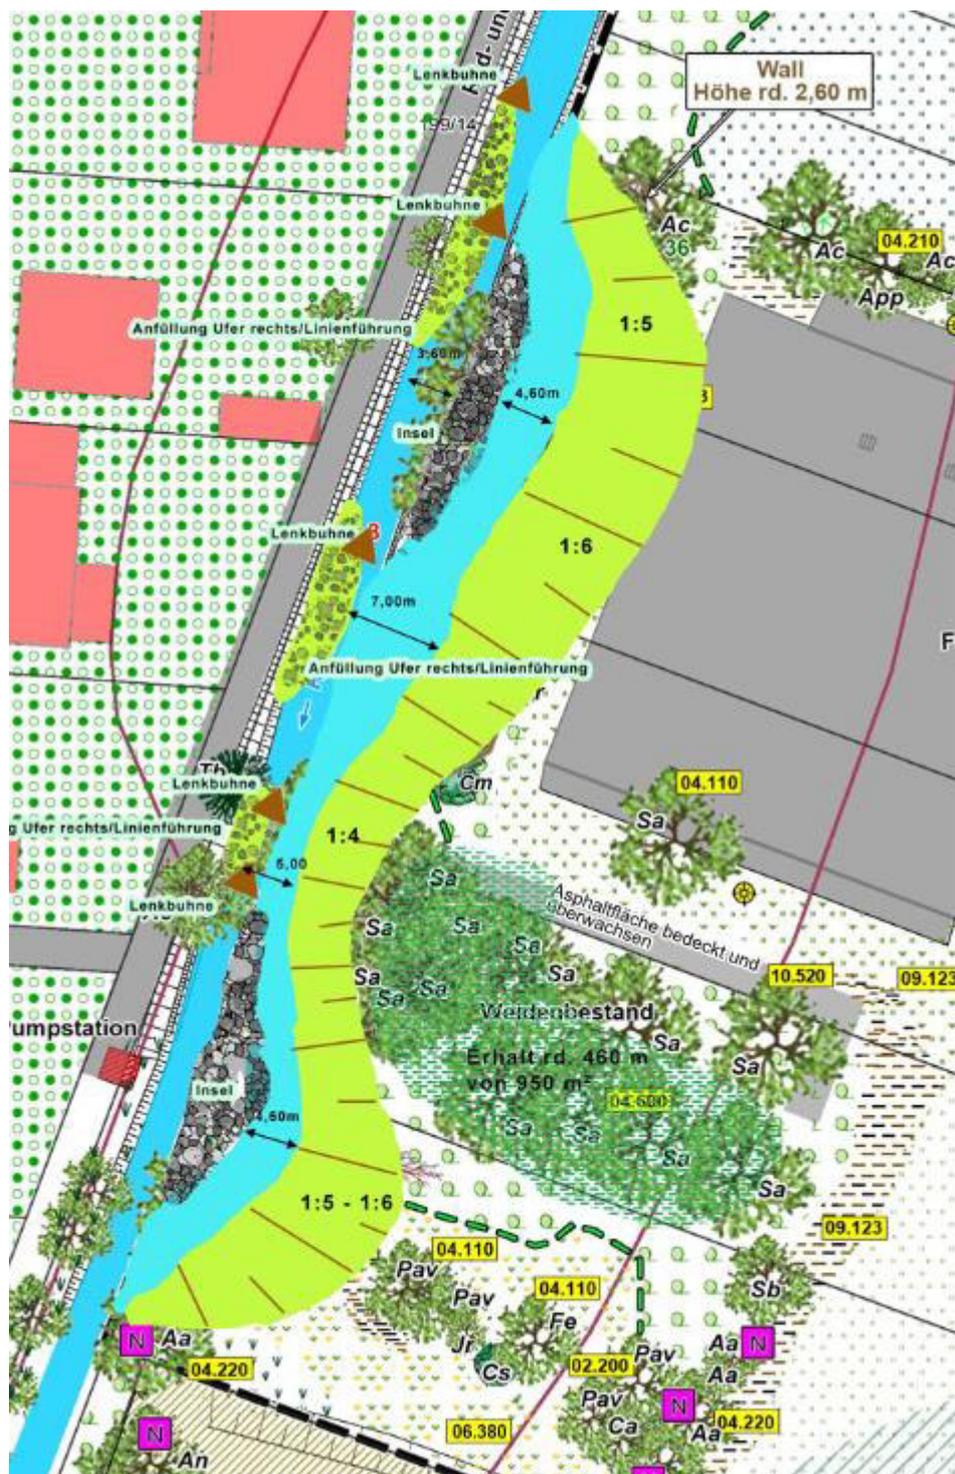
Geplante Renaturierungsmaßnahmen am Krebsbach.
